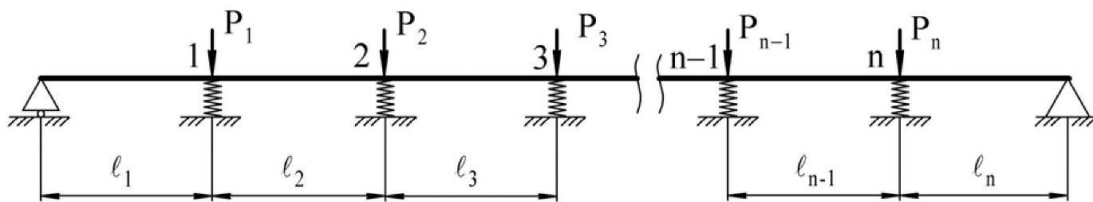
Розрахункова схема трубопровідного переходу з підтримуючим елементом робочого трубопроводу у вигляді ферми
